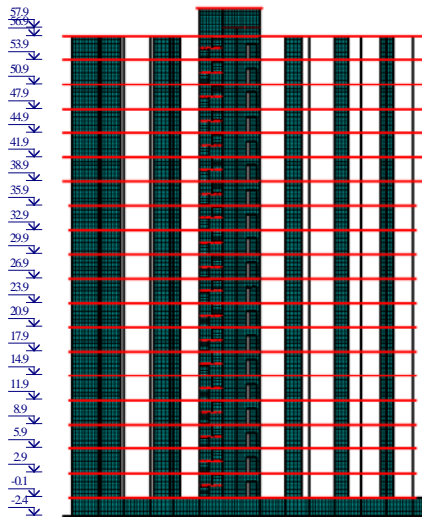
Плиты перекрытий и покрытия – 200 мм
